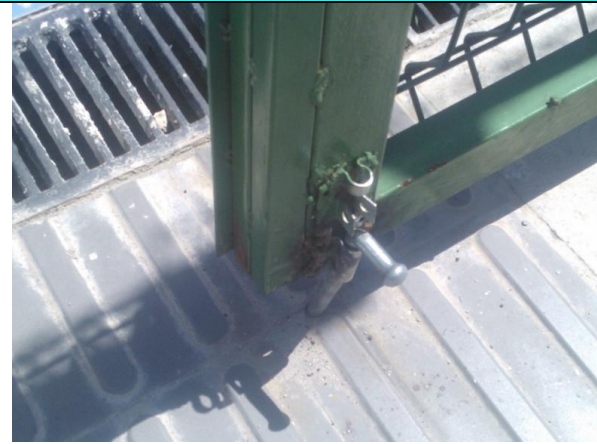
Furo mal executado e Ferrolho enferrujado e mal colocado no portão principal.
